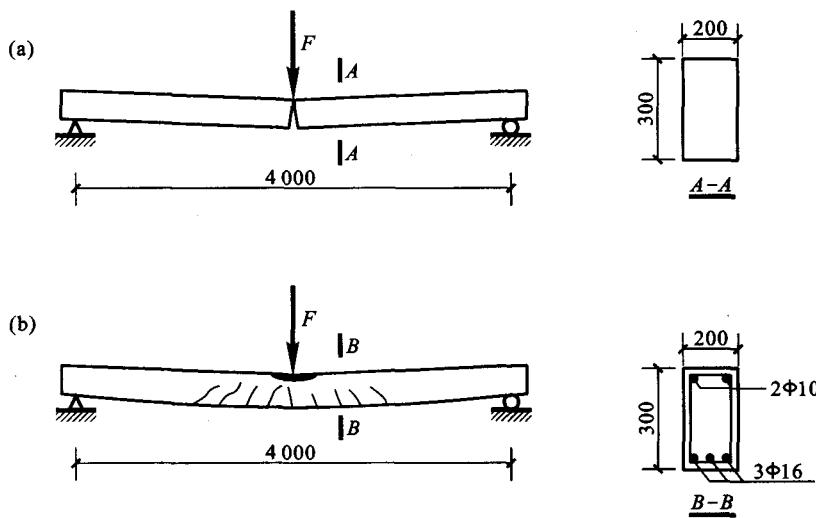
素混凝土梁与钢筋混凝土梁的破坏情况对比
